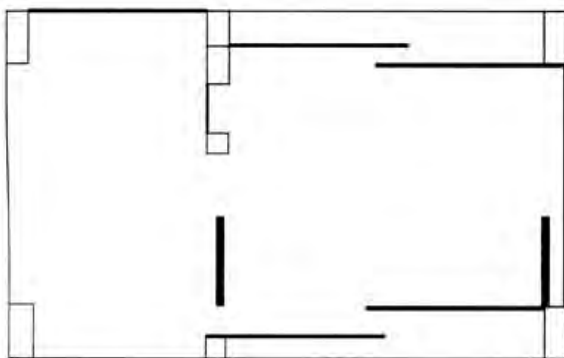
Шлюз с двухстворчатыми дверьми
